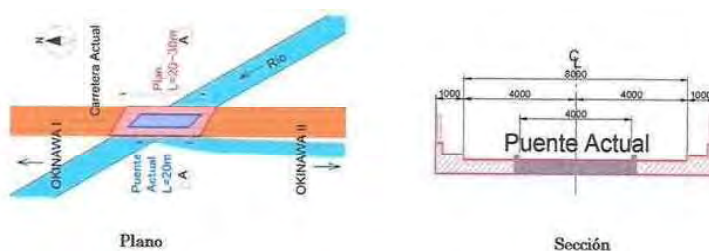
Plano de ubicación del puente a ser reconstruido
